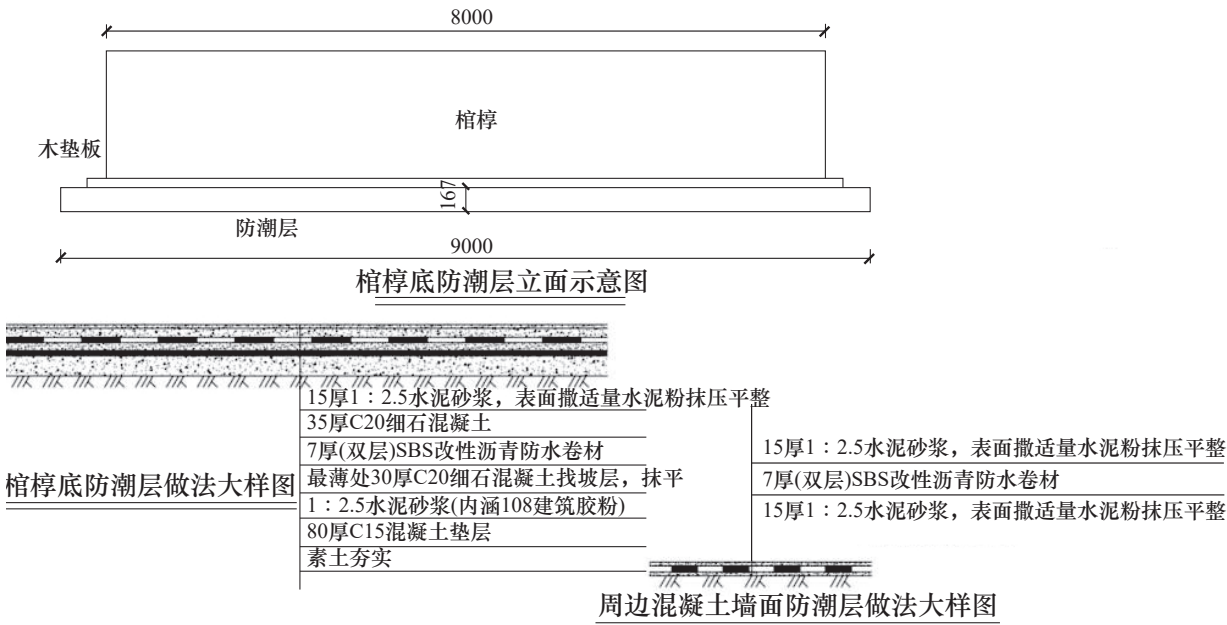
棺椁底防潮层立面示意图、做法大样图、周边混凝土墙面防潮层做法大样图
